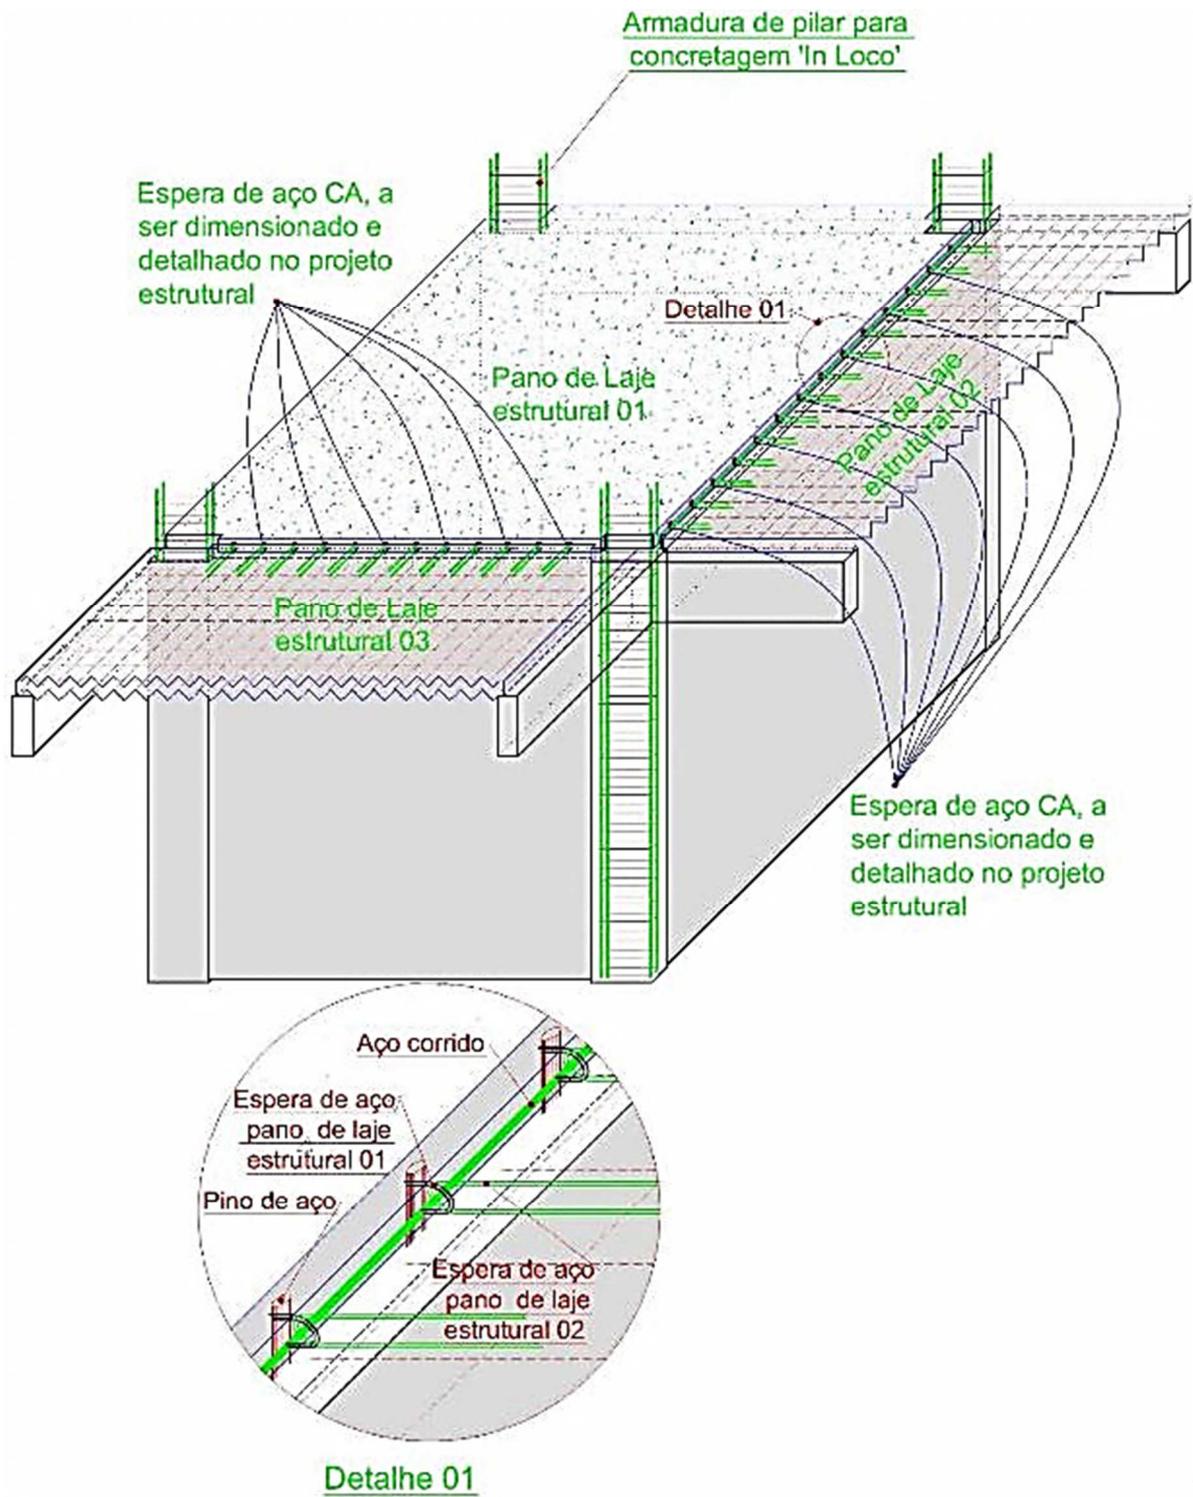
Desenho esquemático das ligações entre lajes e viga.
